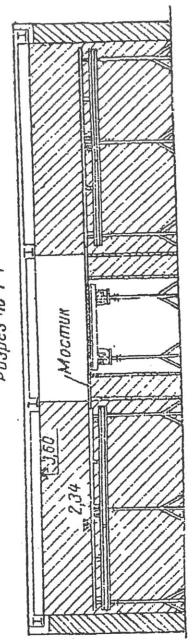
Третий этап — кладка междукомнатных стен до отметки 3,5 м
